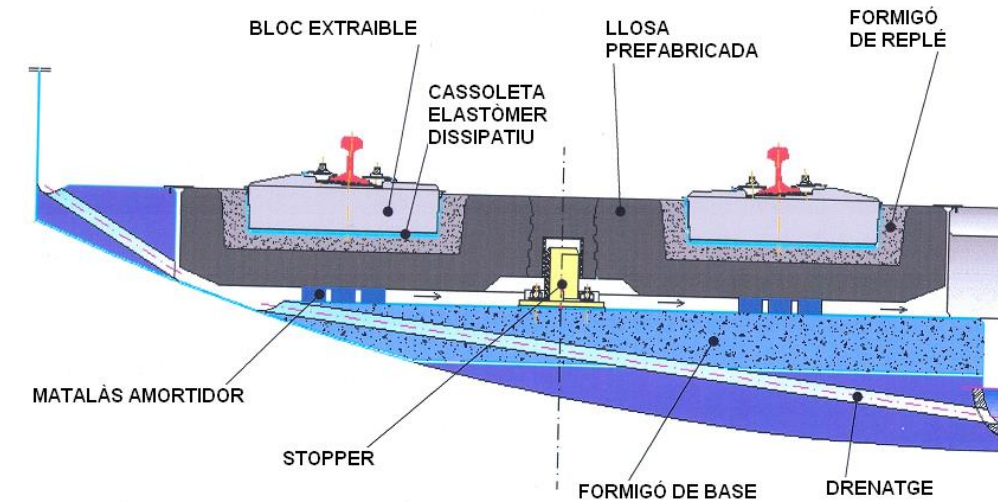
Secció tipus via en placa prefabricada sobre llosa flotant
